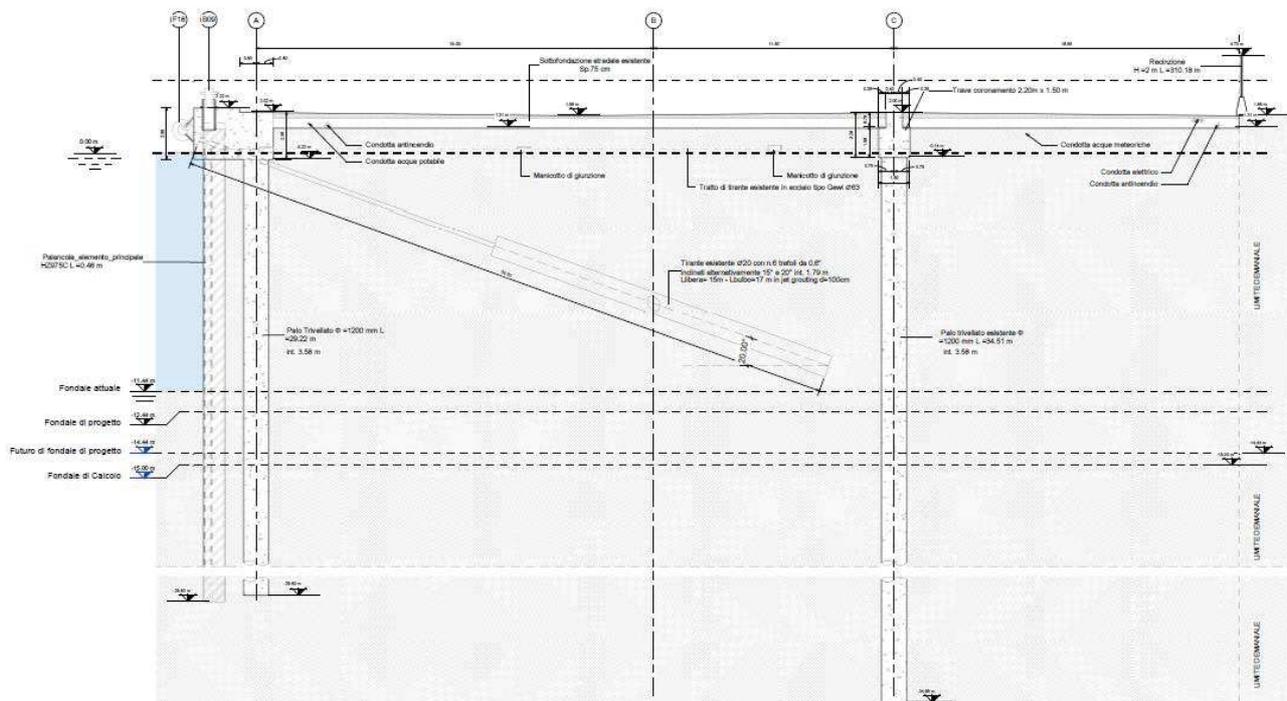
Estratto da elaborato del PD -1114.STR.10.02 - Stato Attuale Planimetria e Sezioni_Rev.2
